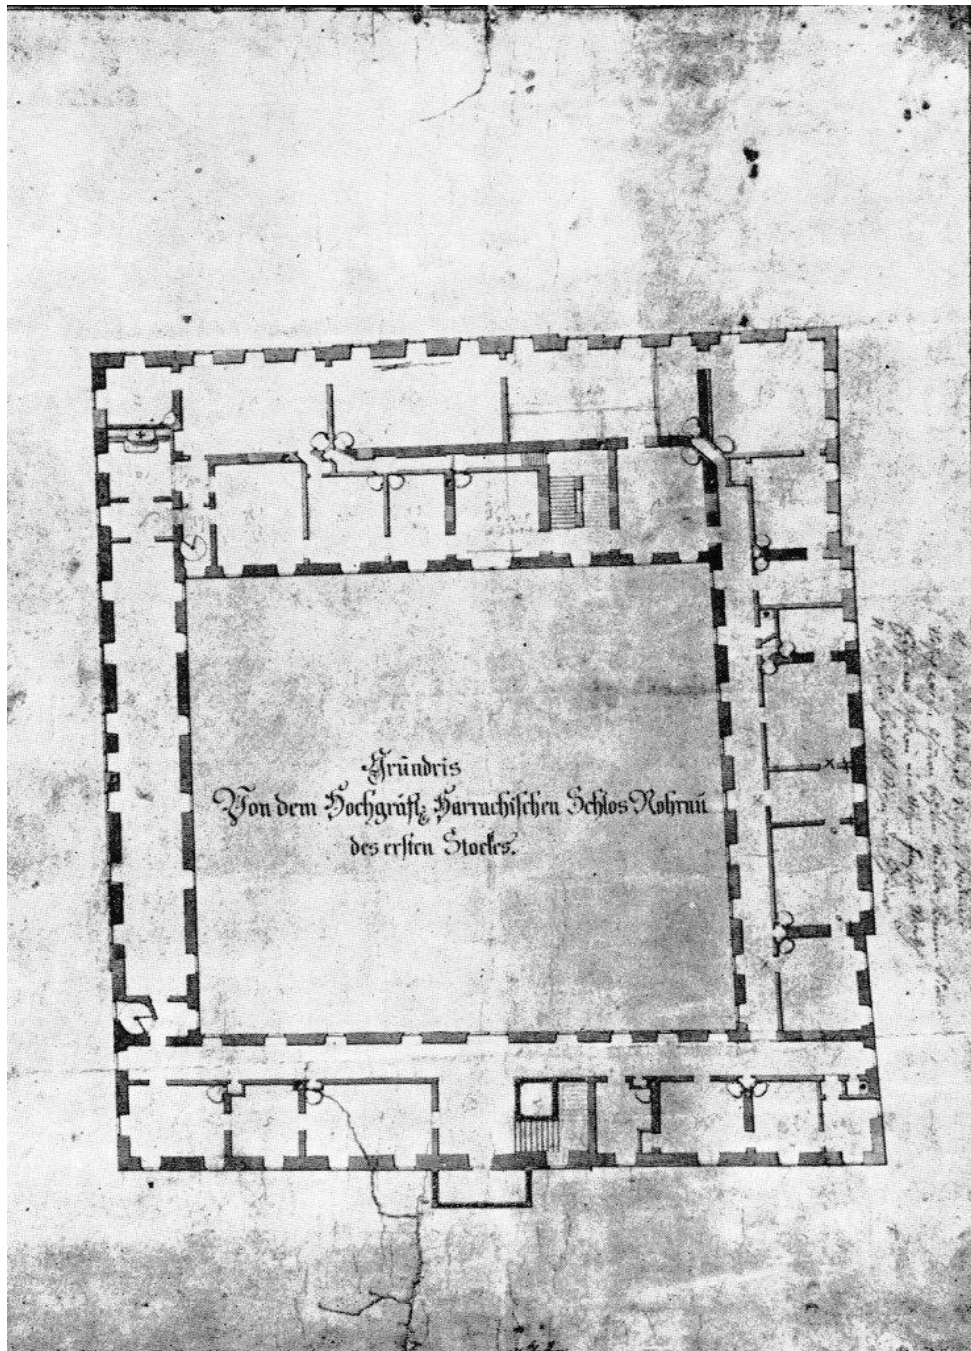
Schloss Rohrau, Grundriss des Obergeschosses von Andreas Zach, Rohrau Archiv.
